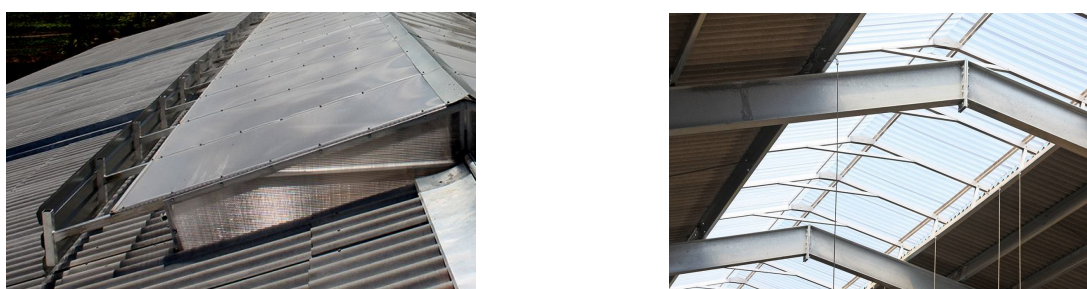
Световентиляционный конёк (вид сверху и снизу)
